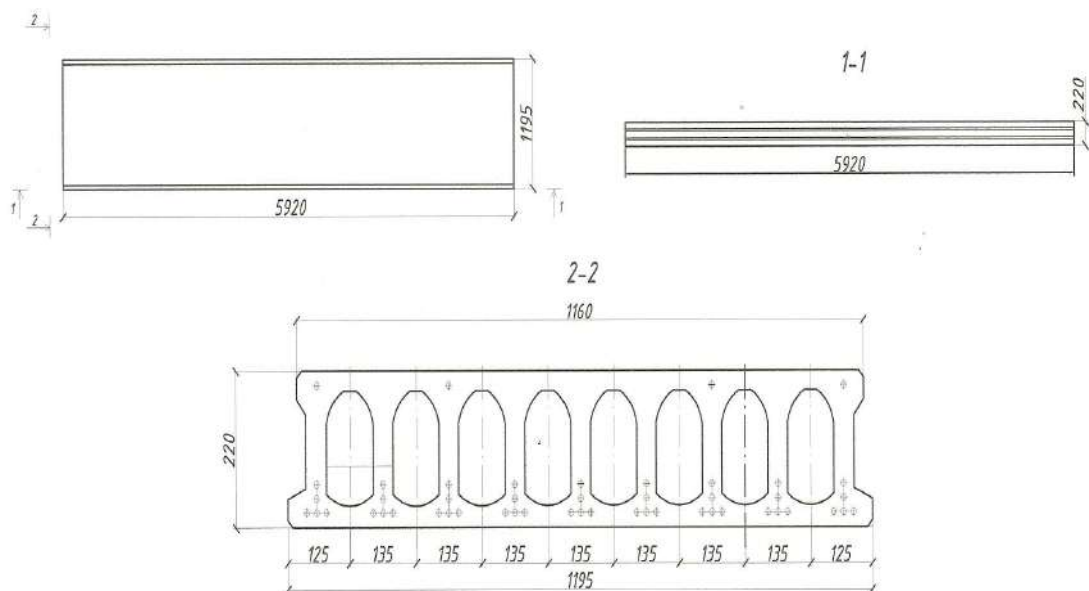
Плита перекрытия многопустотная ПБ-60.12
